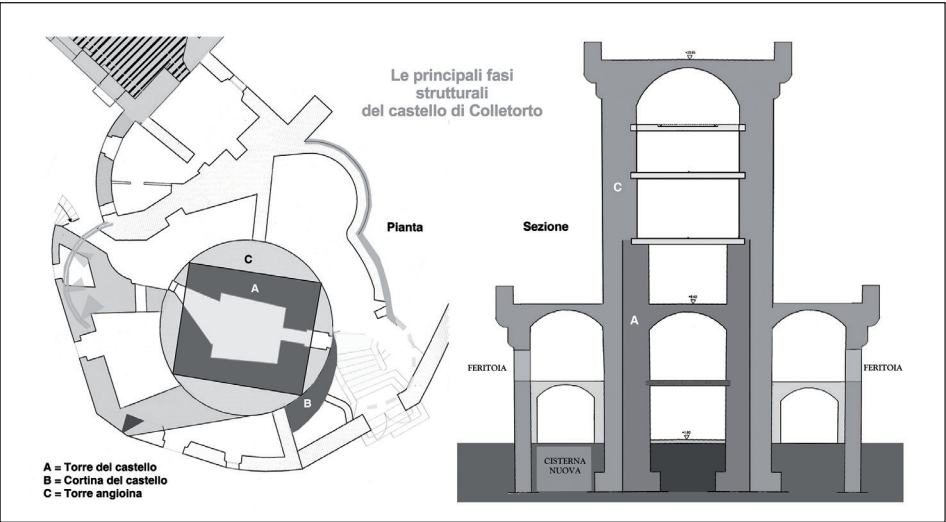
Pianta e sezione del castello normanno di Colletorto.
